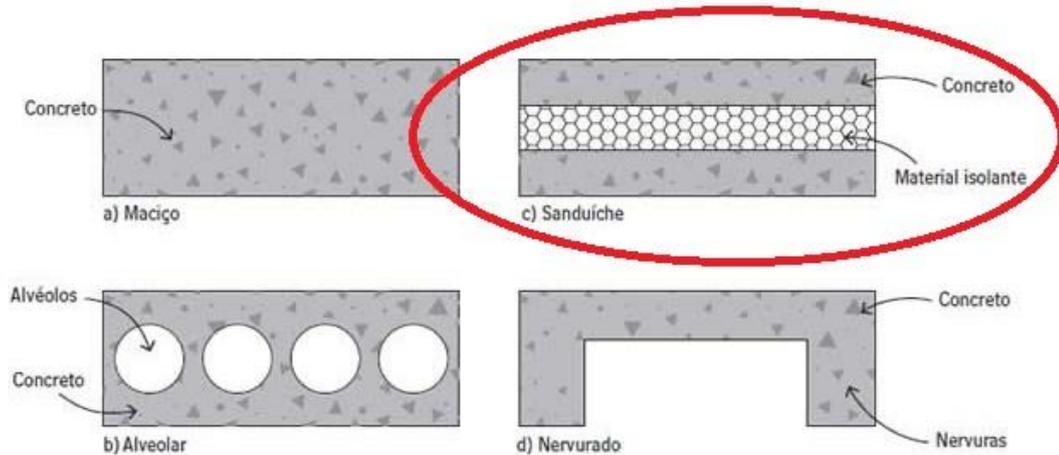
Tipologias de painéis pré-fabricados de concreto. FONTE: TÉCHNE (2011).
